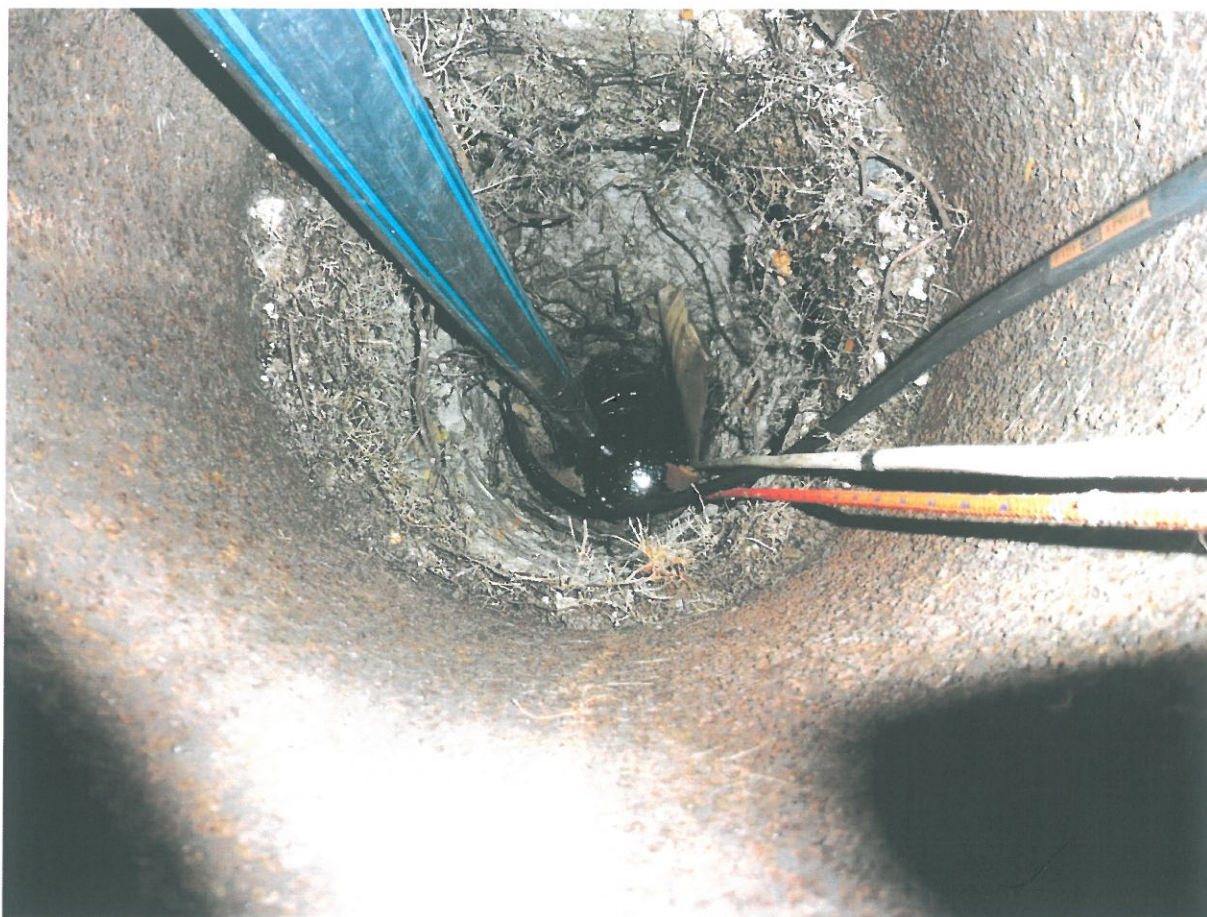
,23: Vrt HV-3A s porušenou zárubnicí (foto Ing. Koštel)
